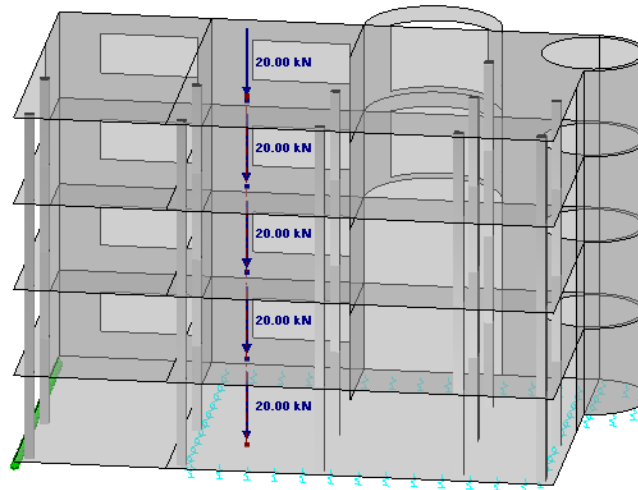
Carga puntual libre actuando sobre el forjado: plano de proyección de carga XY con impacto sobre la losa del techo y la losa del piso
